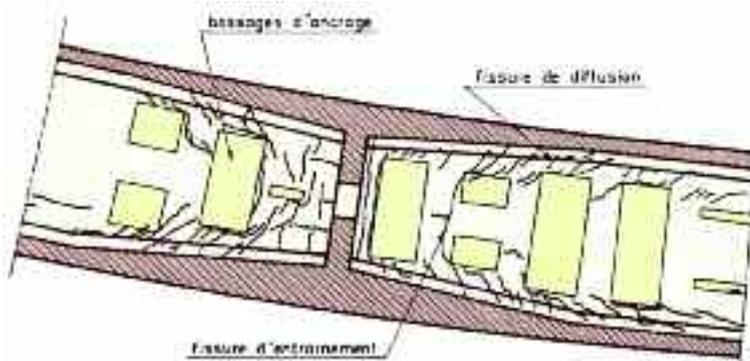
état de fissuration du viaduc de Terrenoire
